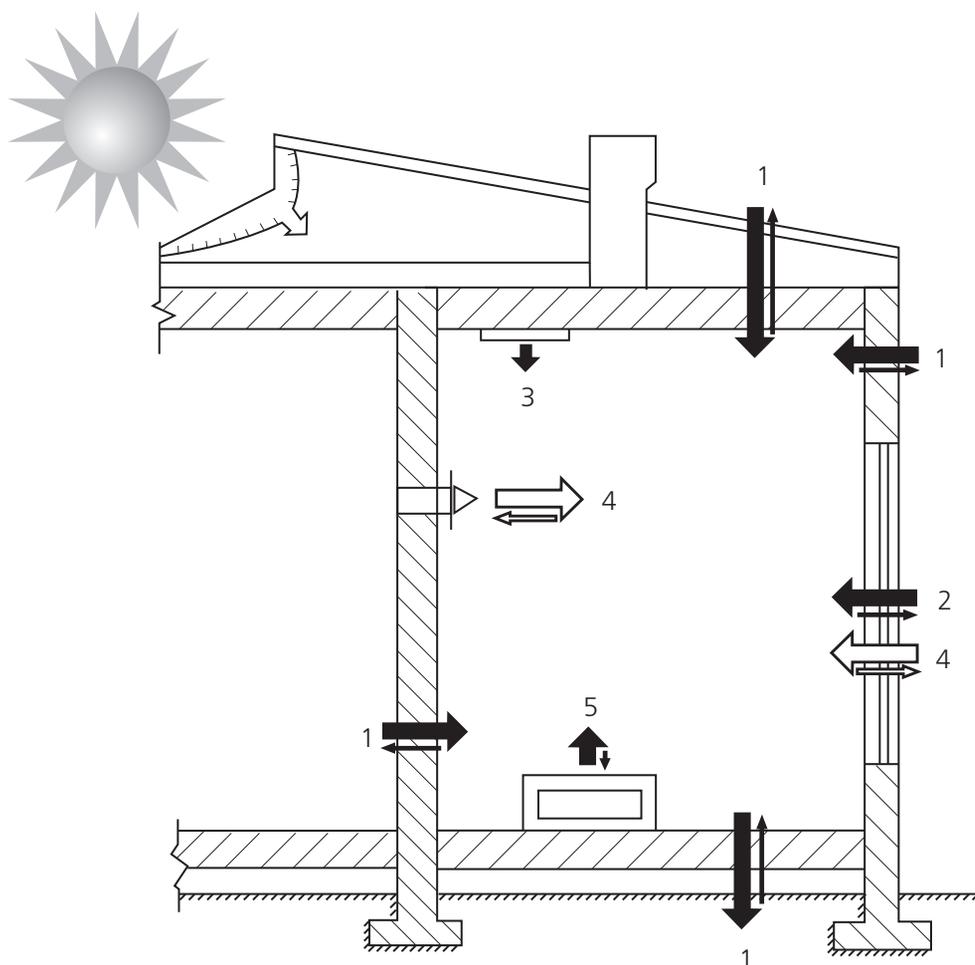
Схема теплового баланса помещения: теплотери или тепlopоступления:
